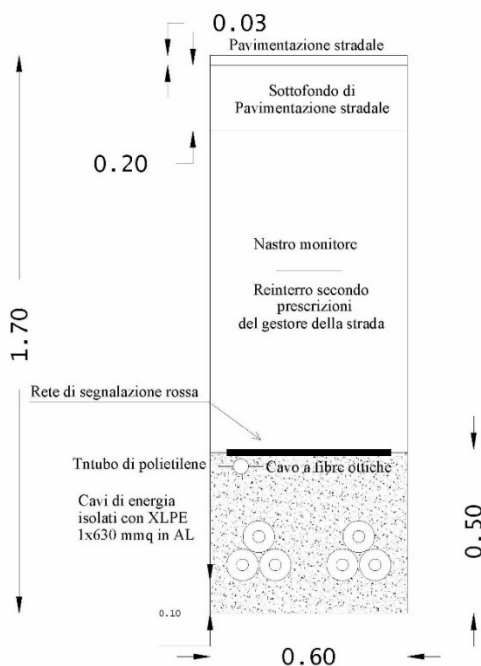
Sezione Cavidotto di connessione 36 kV con la stazione RTN 380/150/36 KV
